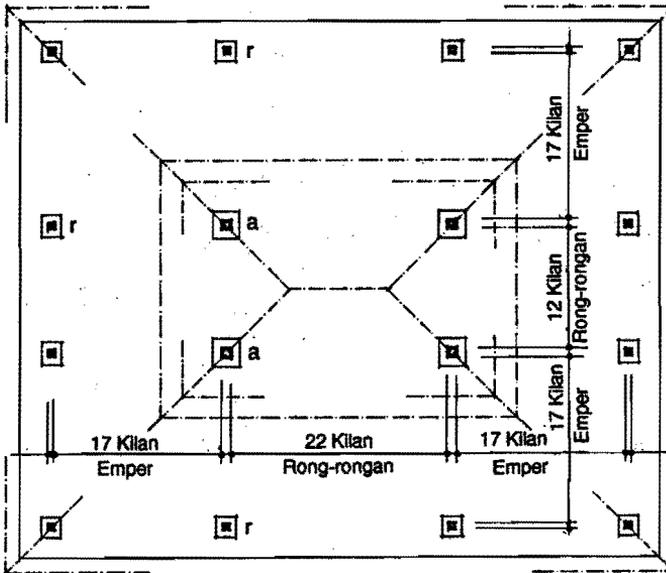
Grundrissanordnung eines Pendopo
